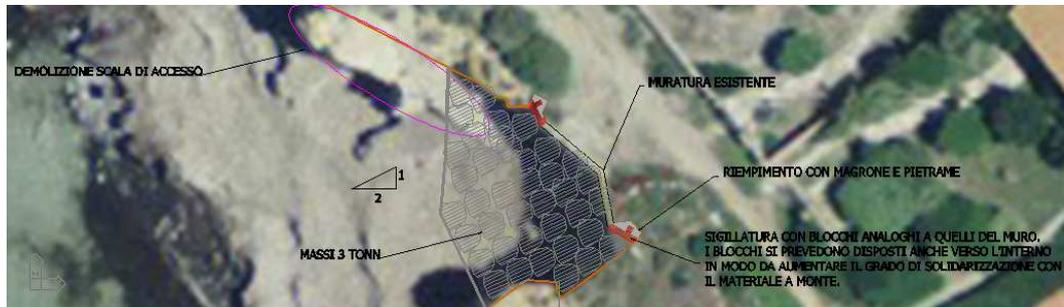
Planimetria della sigillatura del muro esistente con scogliera antistante
